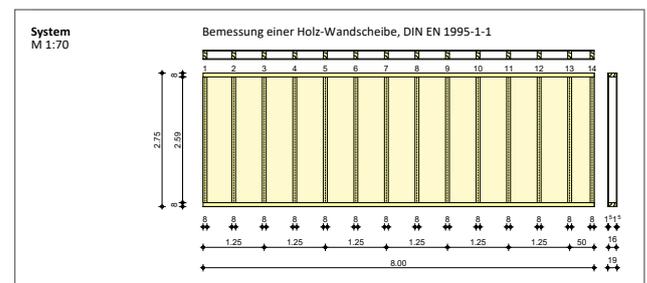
Darstellung einer Holz-Ständerwand in der Statik
